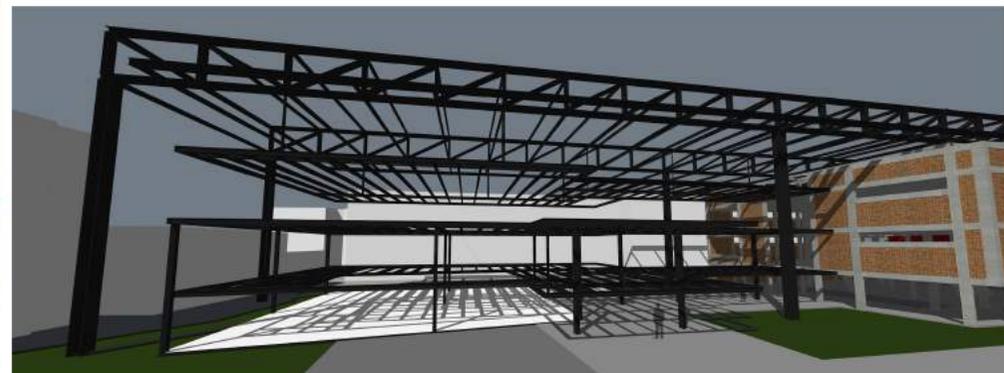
Projeto Estrutural - Bloco 02 - Vista Serviç o Para so dos Inglese
